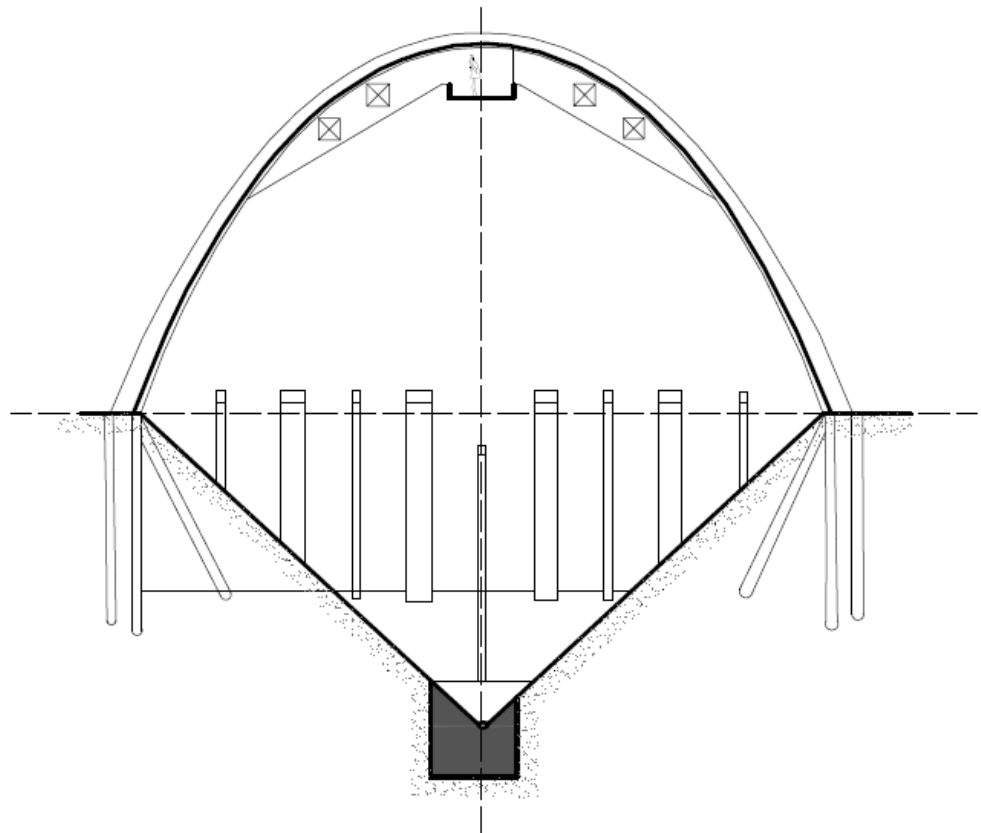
corte transversal do silo CADYL redesenhado pelo autor.
